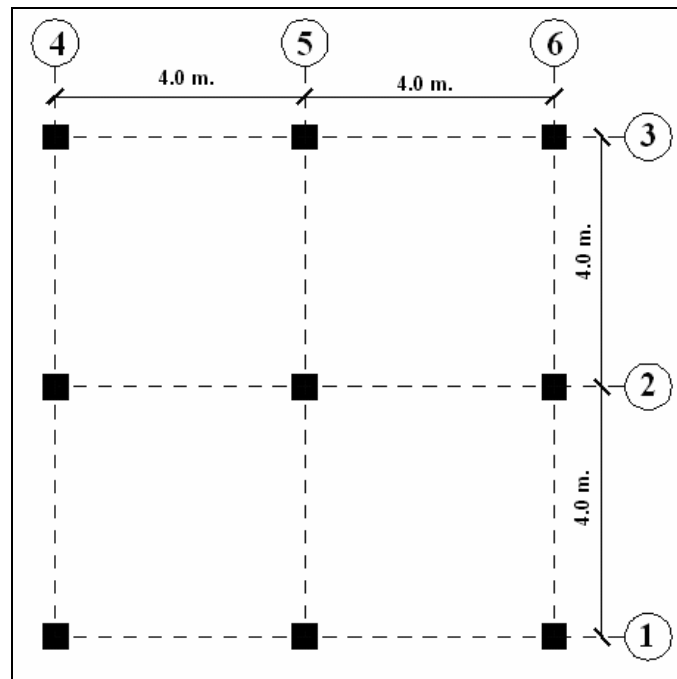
Distribución en planta de 6 estructuras analizadas de 1 a 6 pisos.
